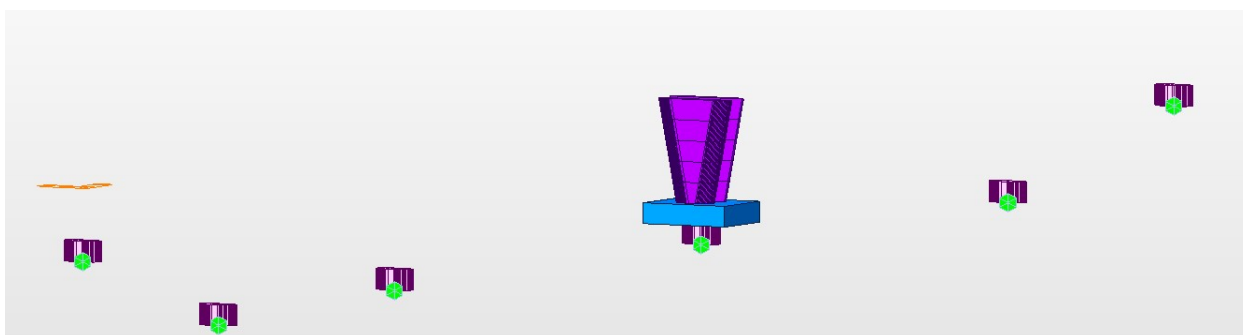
Výpočtový model konstrukce – detail podepření konstrukce u pilíře P4
